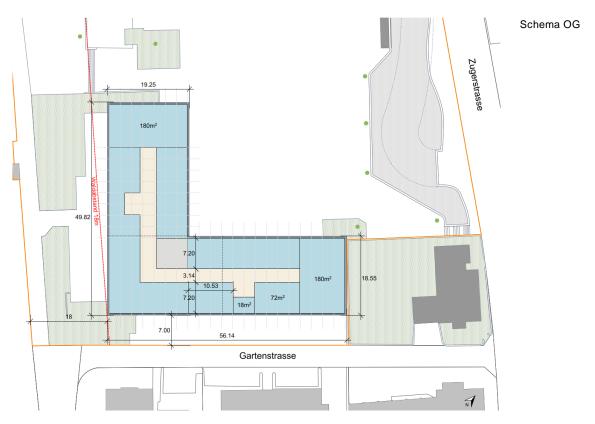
Variante Ersatzneubau inkl. Tagesschule – Schema Obergeschoss
